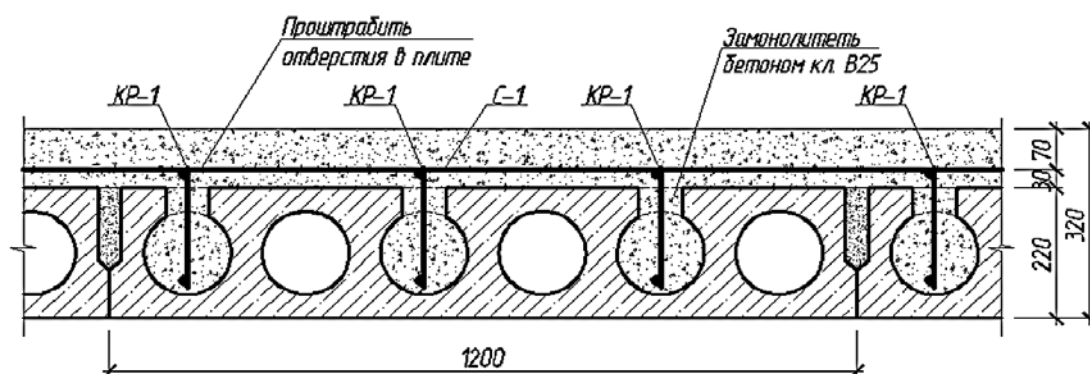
Принципиальная схема усиления многопустотных плит перекрытия
